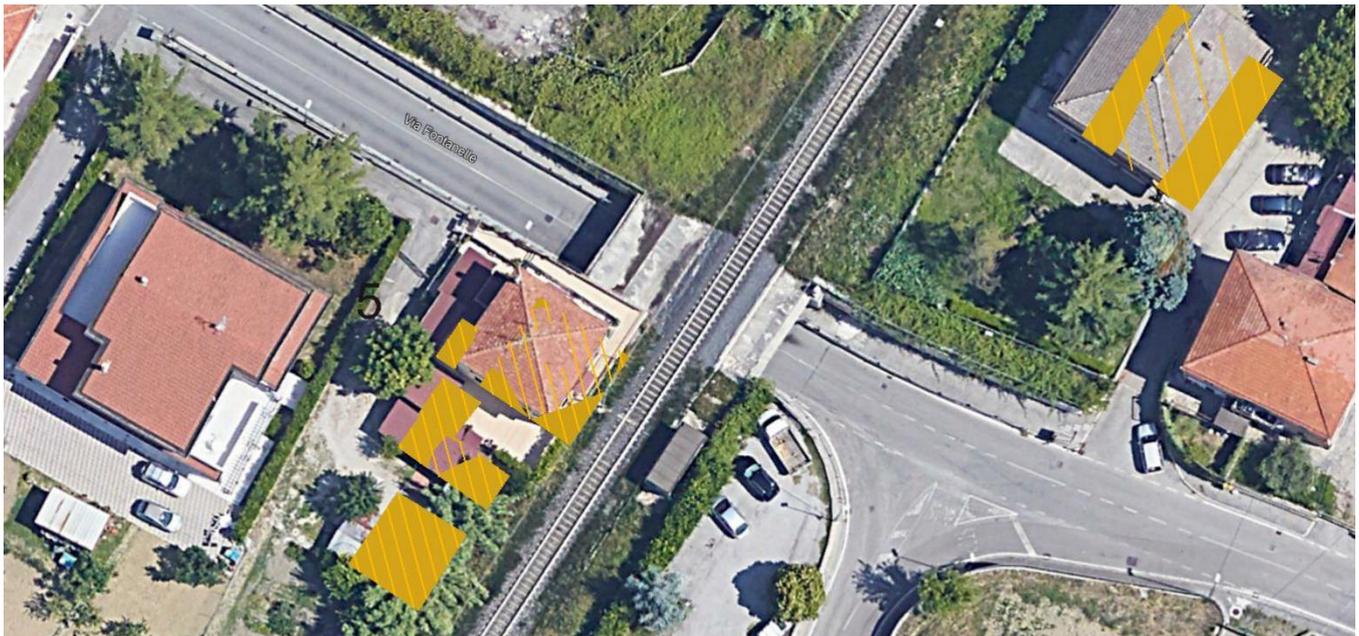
Inquadramento planimetrico Fabbricati 05
